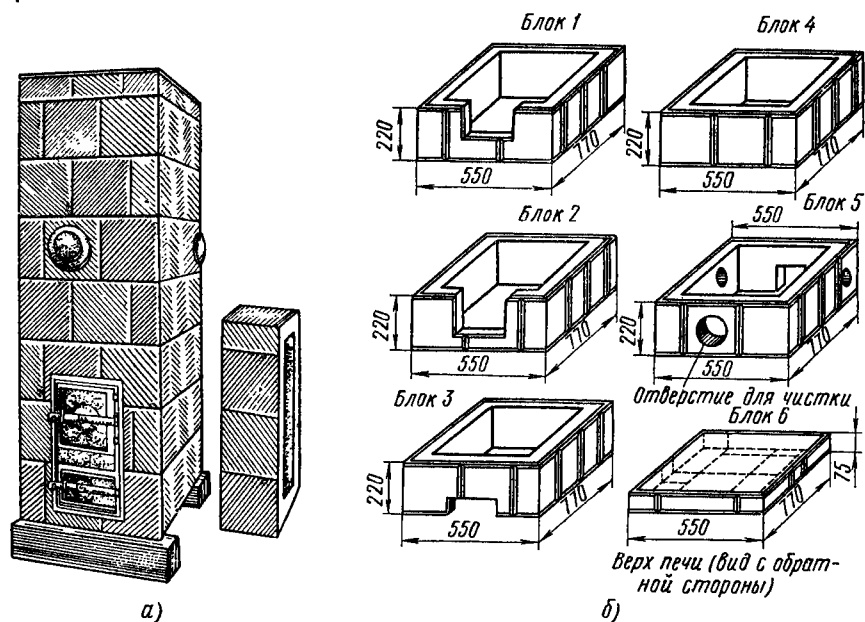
Общий вид (а) и изразцовые блоки (б) сборно-блочной изразцовой печи
